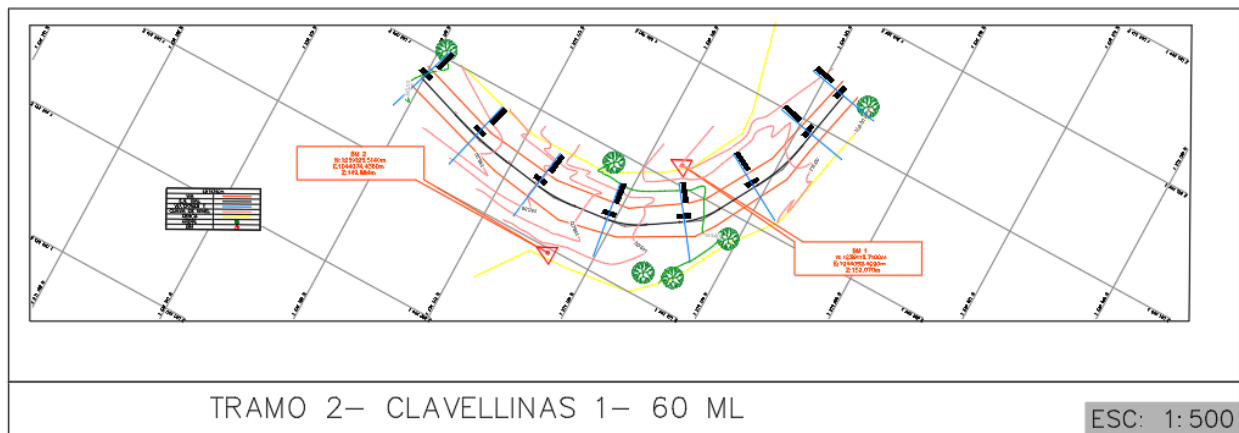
Imagen de planta del tramo 2 del proyecto de San Vicente de Chucuri-Santander
